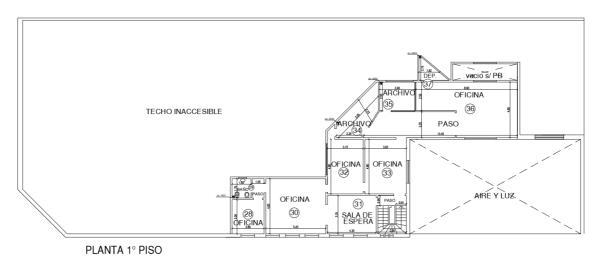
Plano del primer piso en la planta de producción de Smams.
